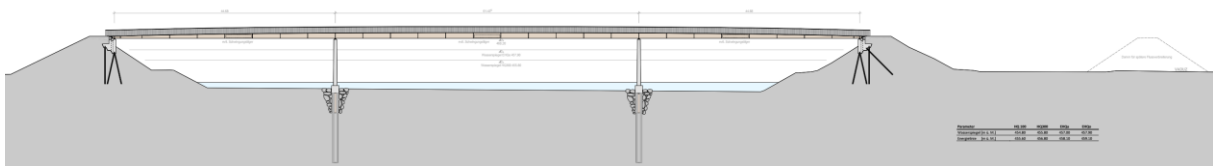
Längsschnitt durch die Brücke mit Fundationen
